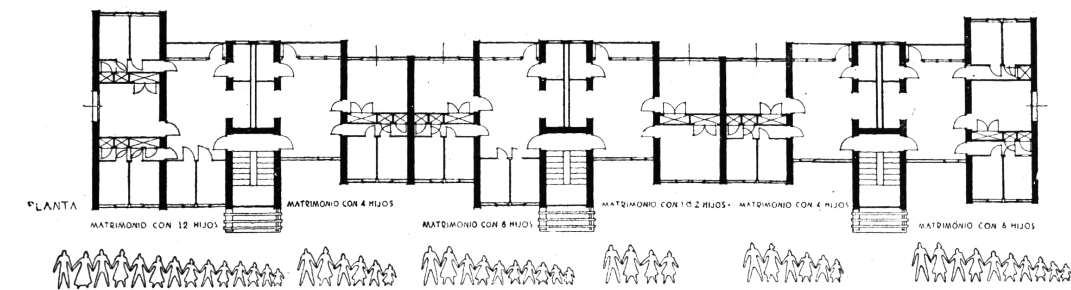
Miguel Fisac Serna, *Plantas tipo. Viviendas en cadena*, 1951. Plano editado por la autora. ([click para ver la fuente, página 153](#))
